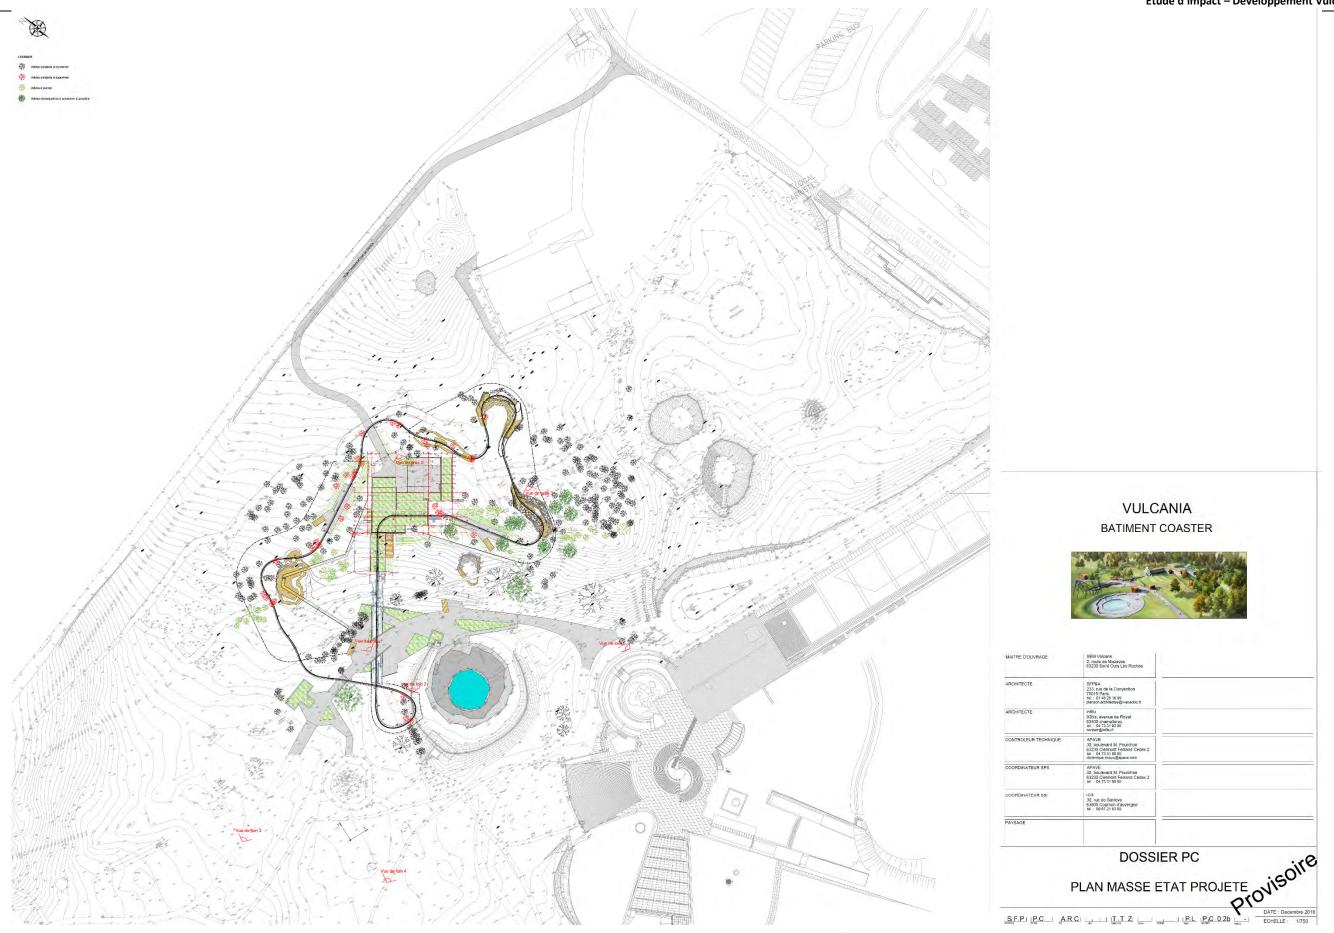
Plan masse du projet RIDE – source : Permis de construire décembre 2018
